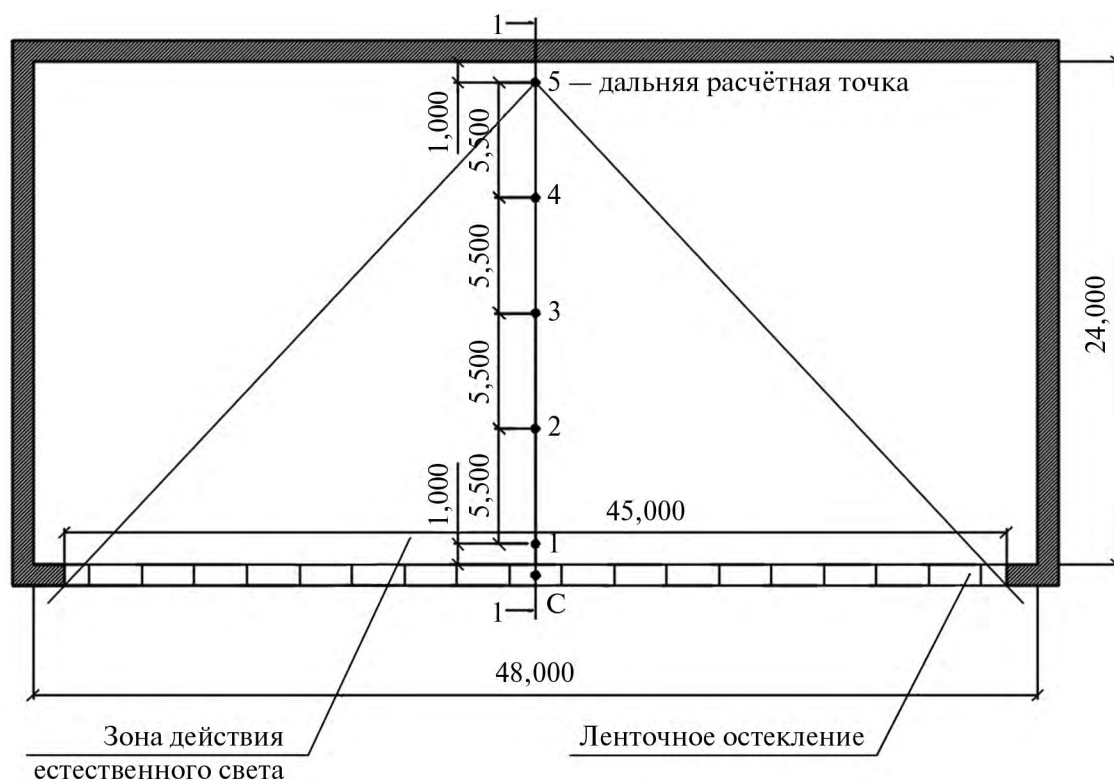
Схематический план и расчётная схема рассматриваемого помещения
